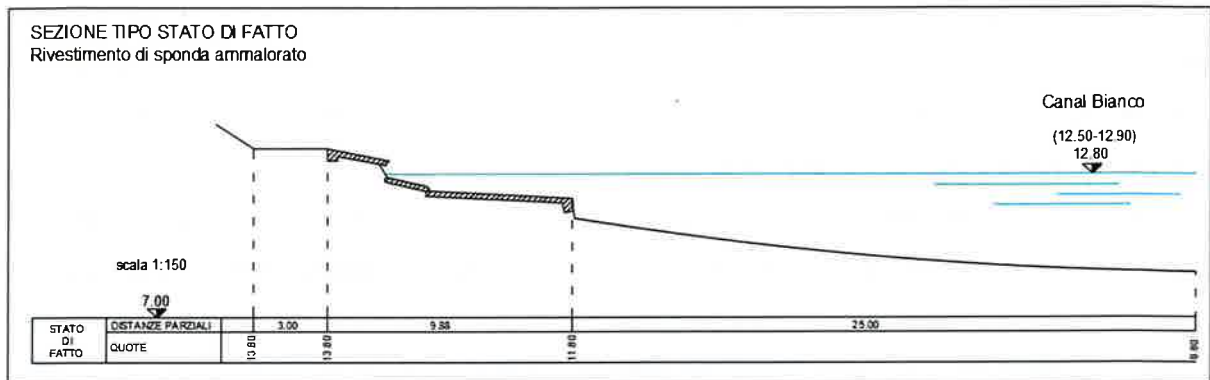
Sezione tipo stato di fatto rivestimento di sponda ammalorato.
